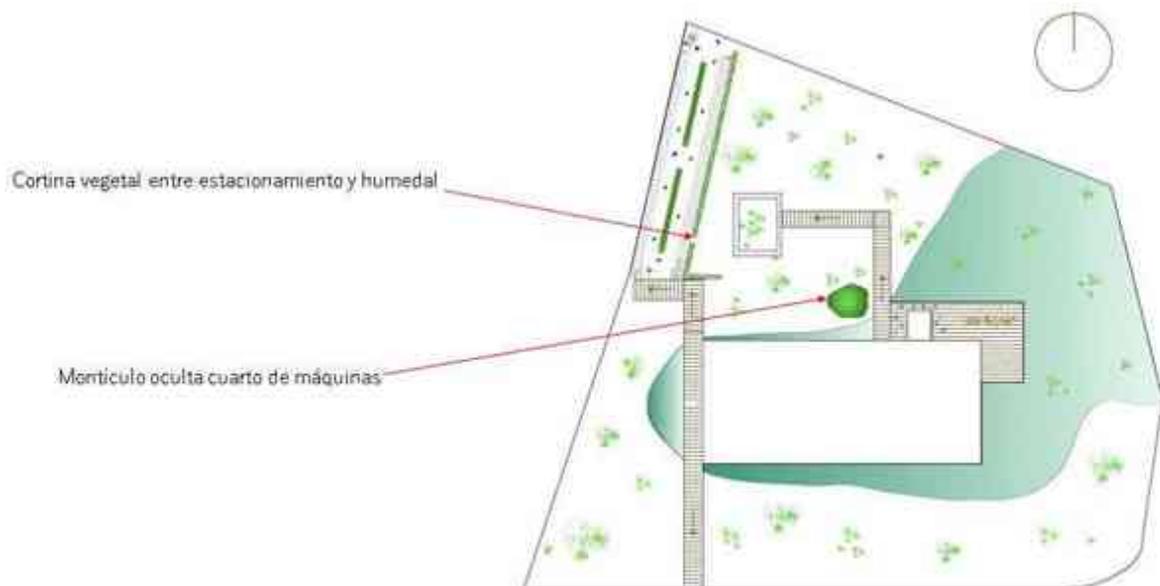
Planta de conjunto. (Fuente: Elaborado por el autor)
